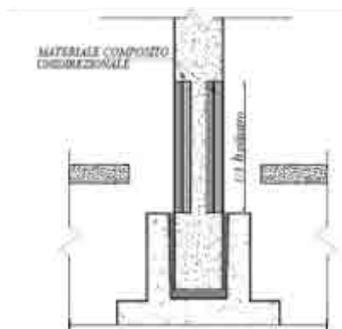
Applicazione del tessuto metallico. Sezione verticale
